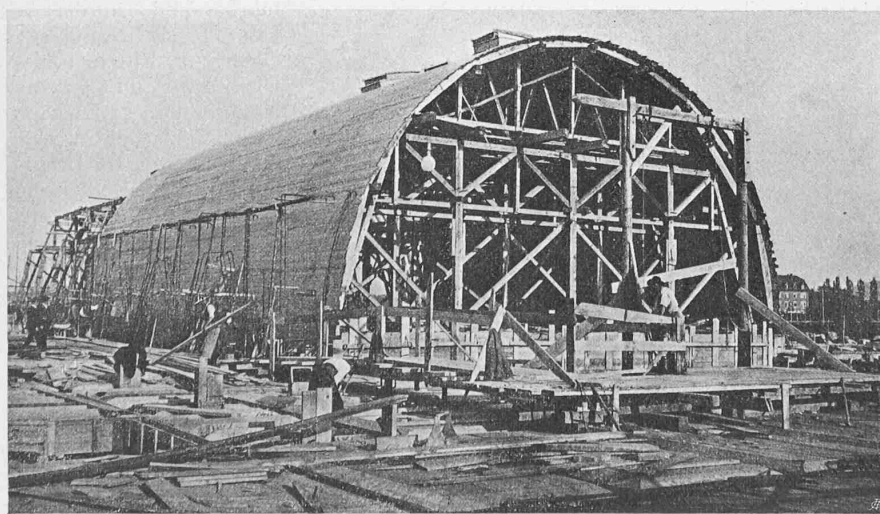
Hallengerüst in Höhe der Erdgeschossdecke.
